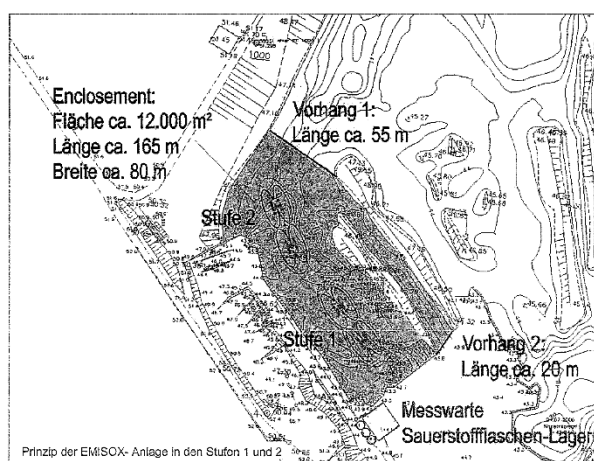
Prinzip Enclosememt Tagebausee, Lageplan
